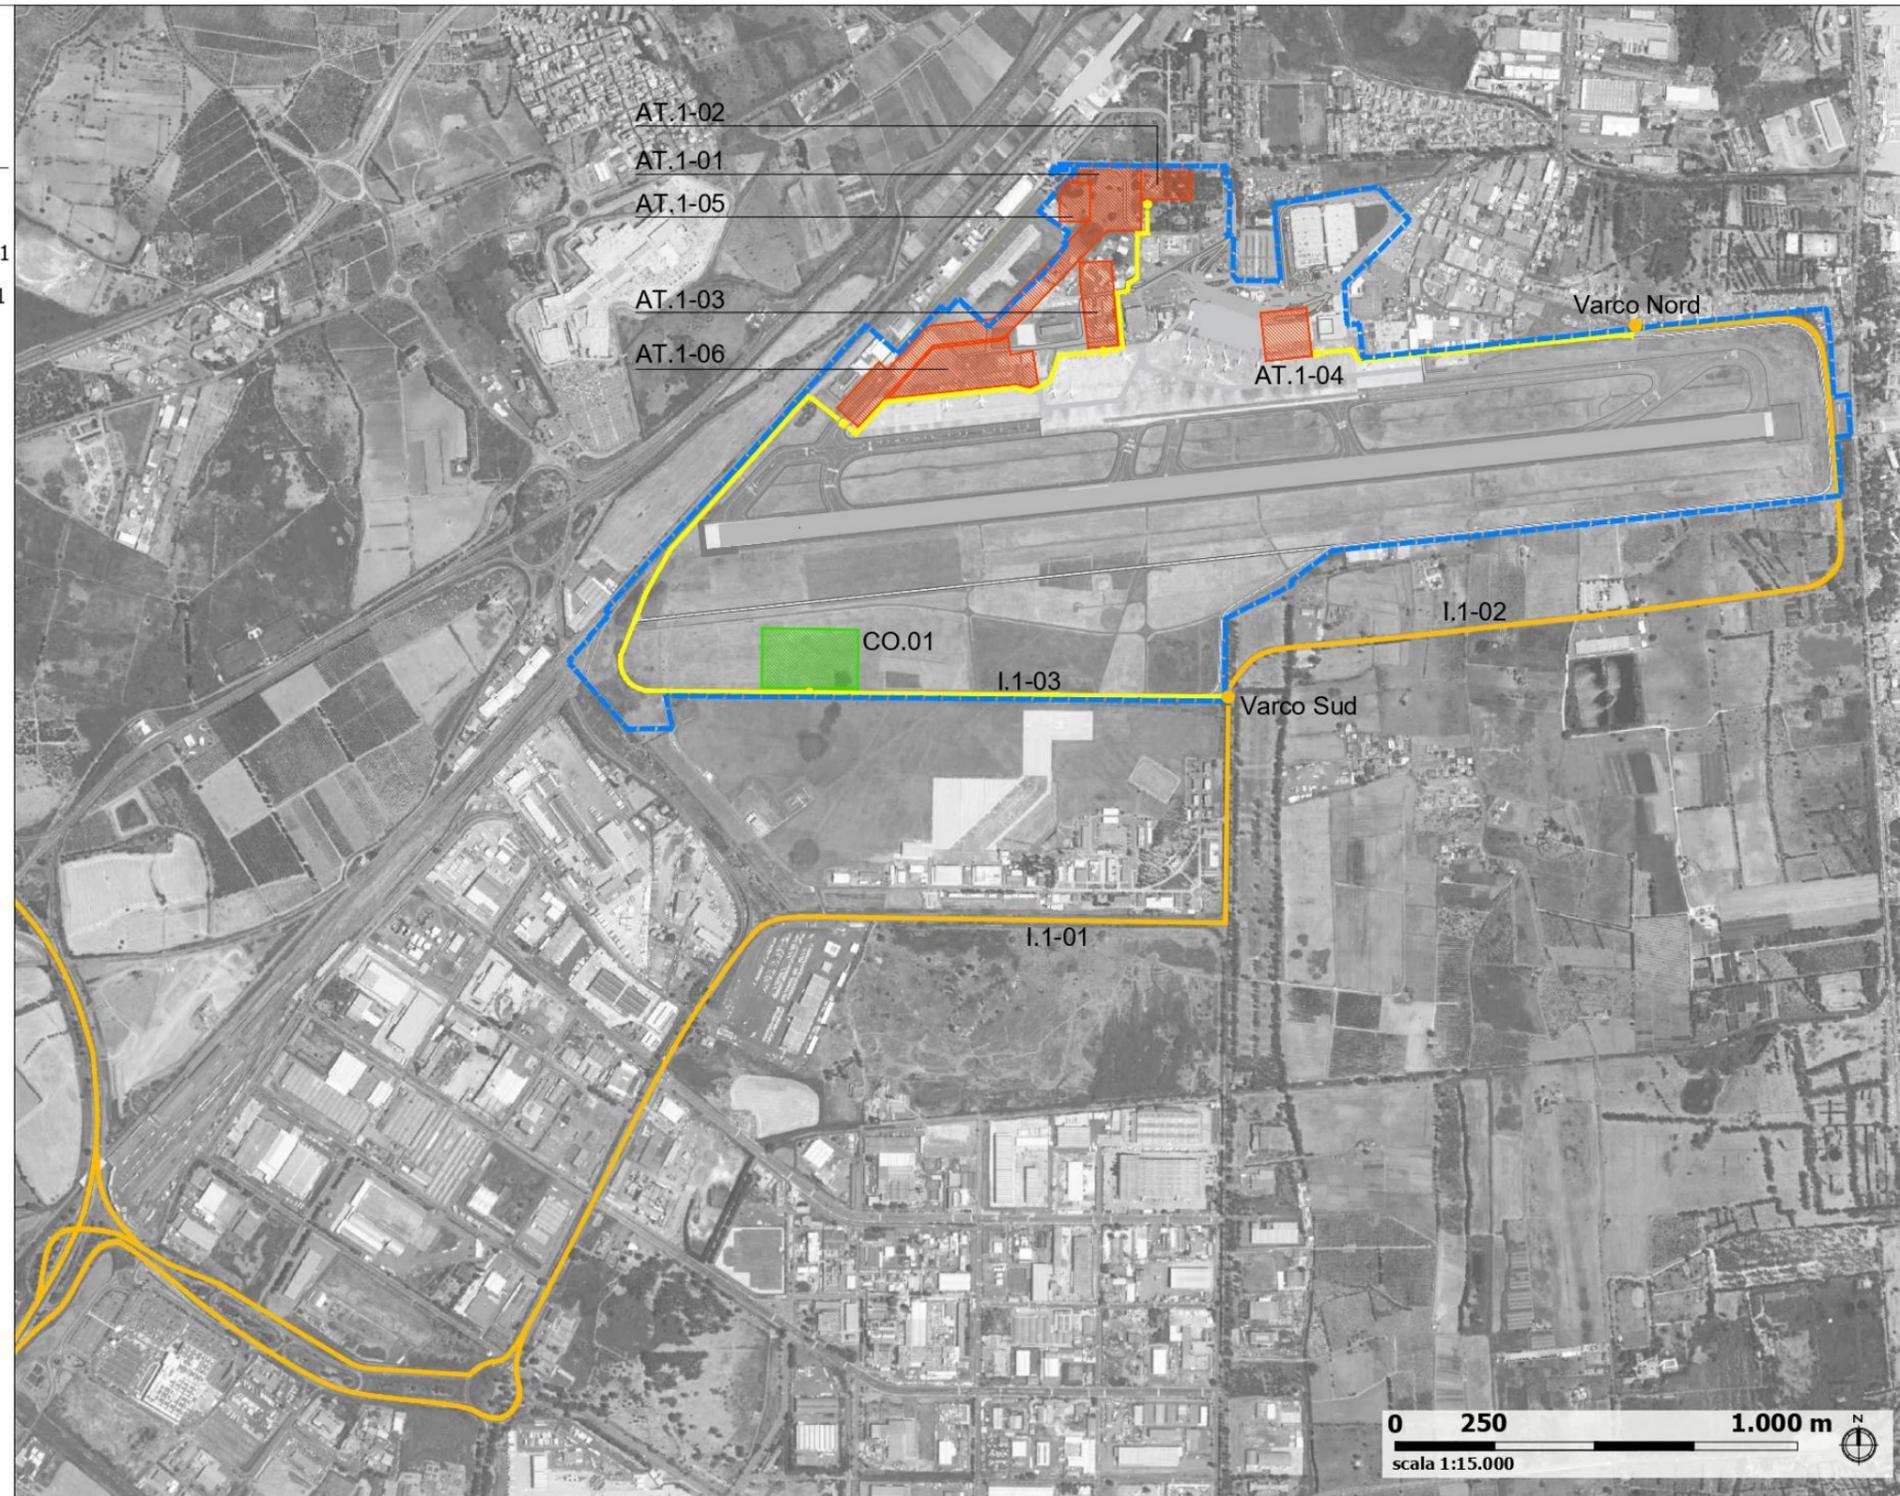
Planimetria delle aree di cantiere di Fase 1
